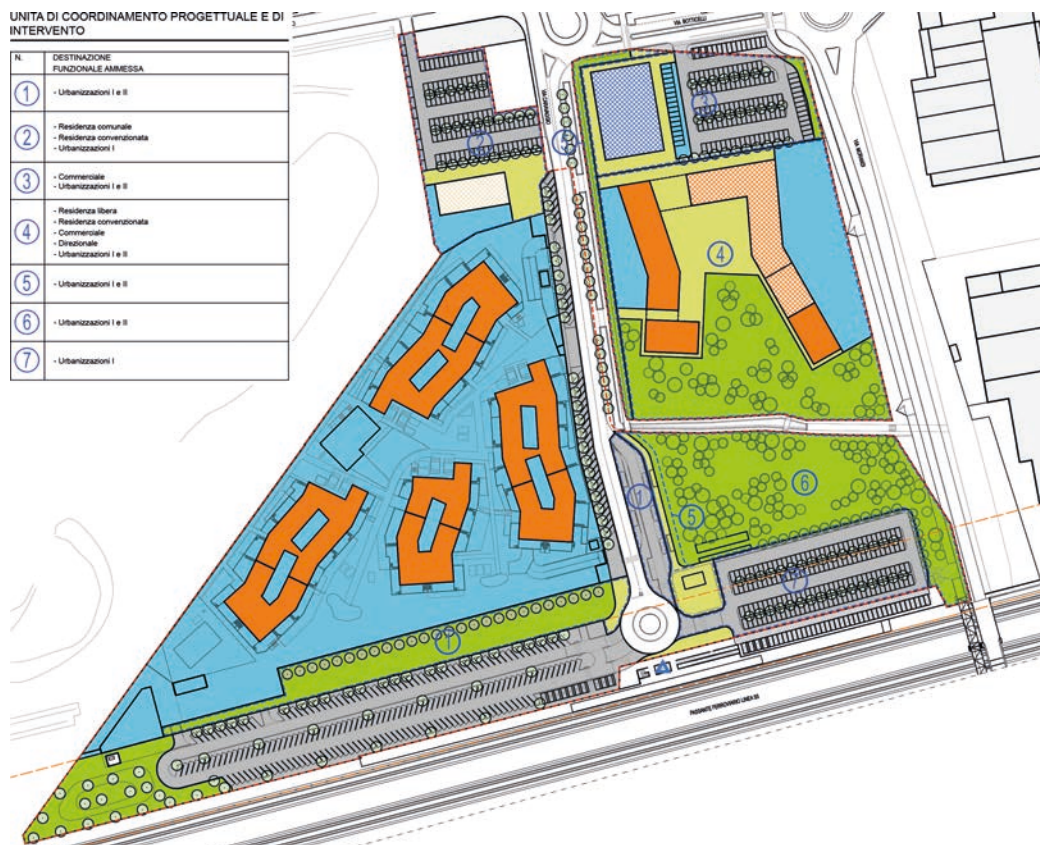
| Estratto della Tavola 4.4 – assetto planivolumetrico proposto variante ultima revisione maggio 2018.
